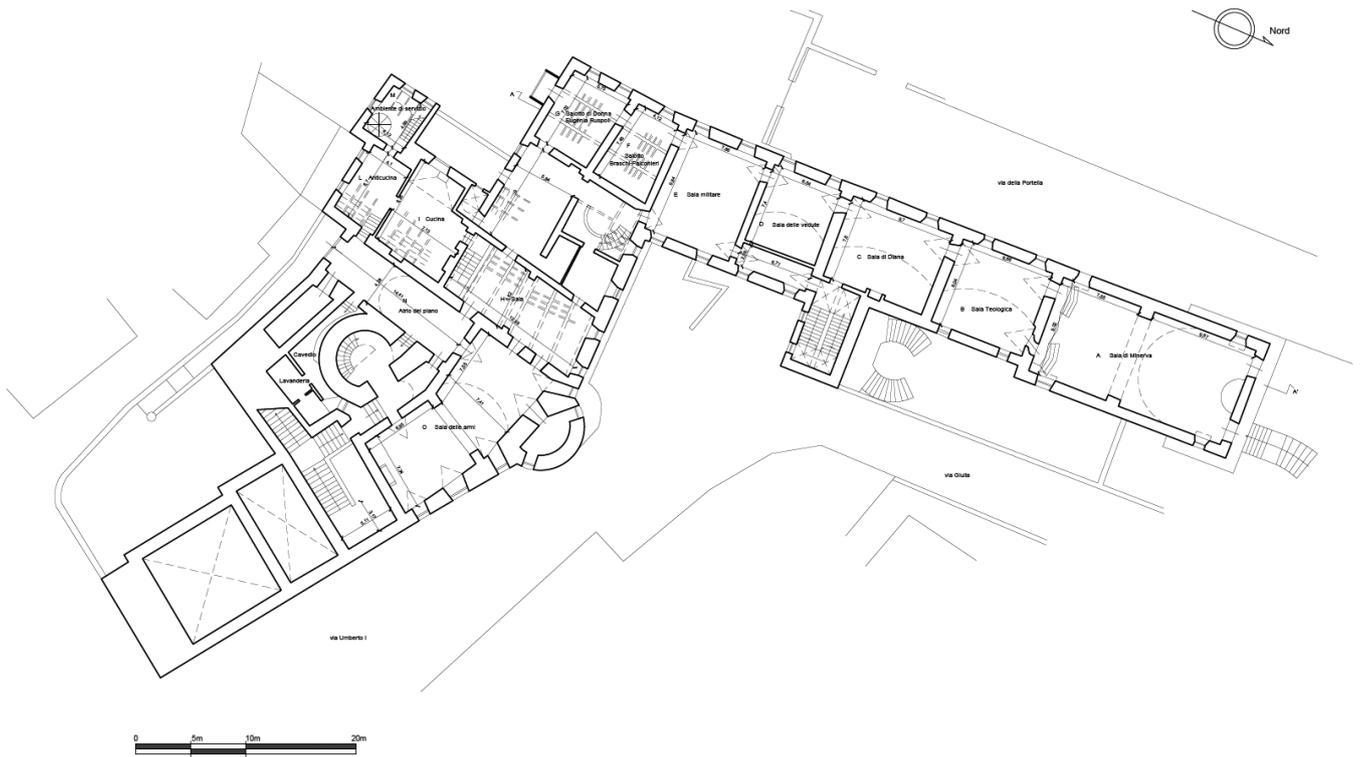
Pianta del piano primo (restituzione grafica D. Calzolaio, 2019).
